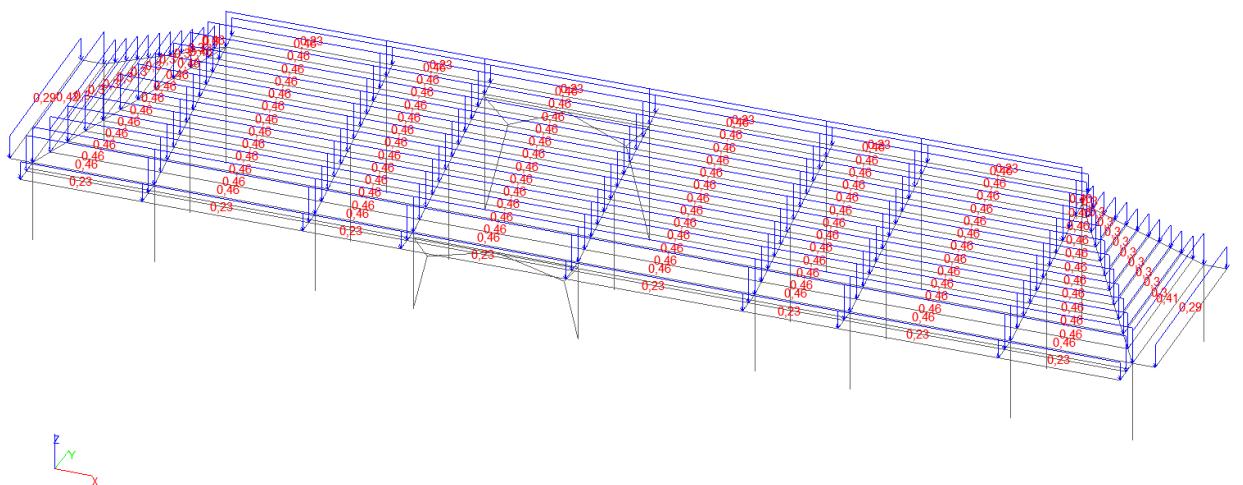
Схема загружения каркаса расчётной нагрузкой от веса кровли
